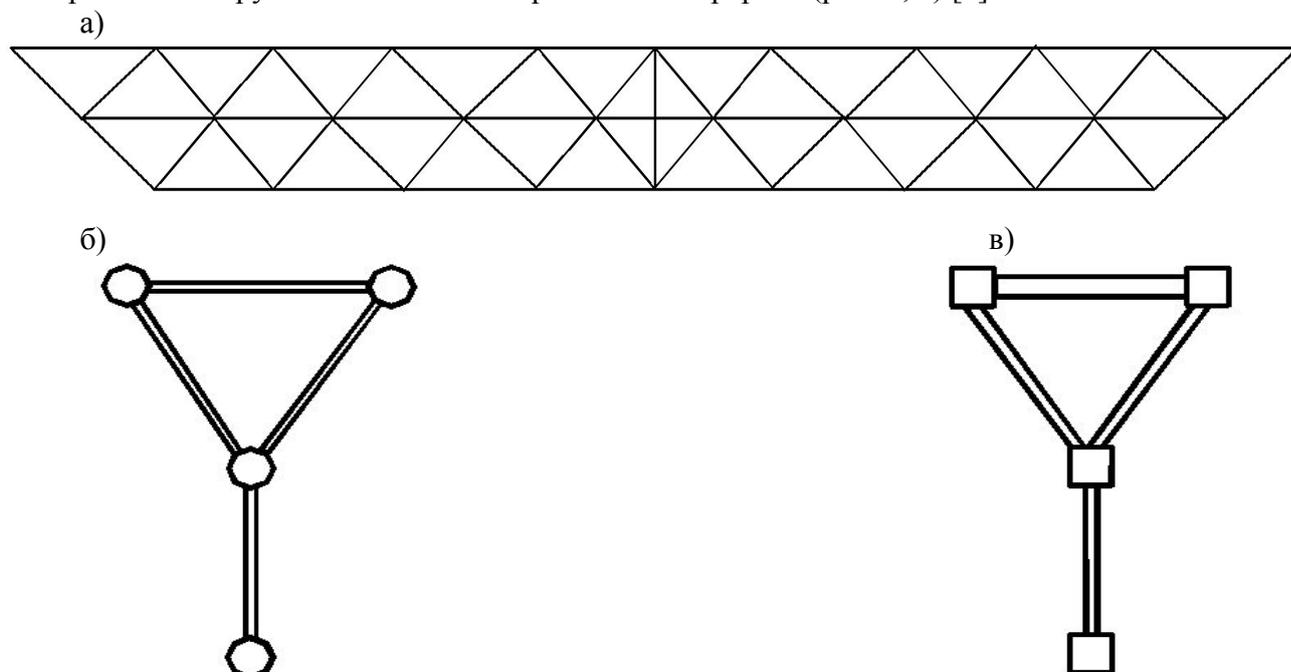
Ферма з просторовим верхнім поясом –а – схема ферми з просторовим верхнім поясом; б – переріз ферм з просторовим верхнім поясом із труб; в – переріз ферм з просторовим верхнім поясом із прямокутних профілів
